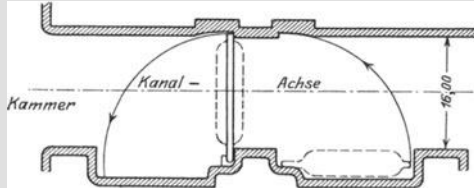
Drehtore der Ostschleuse zu Tancarville. Grundriß. Maßstab 1 : 110.
